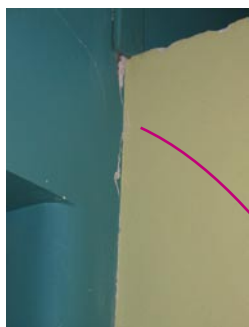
fissures sur poutre de soutien (restaurant scolaire Grand-Champ)
